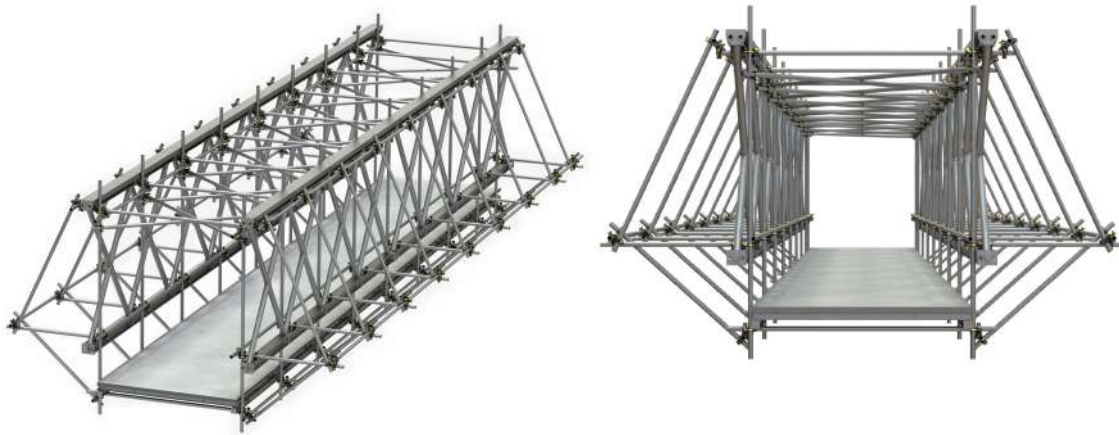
Treliça SH 300 – Passarela Contraventada por fora
